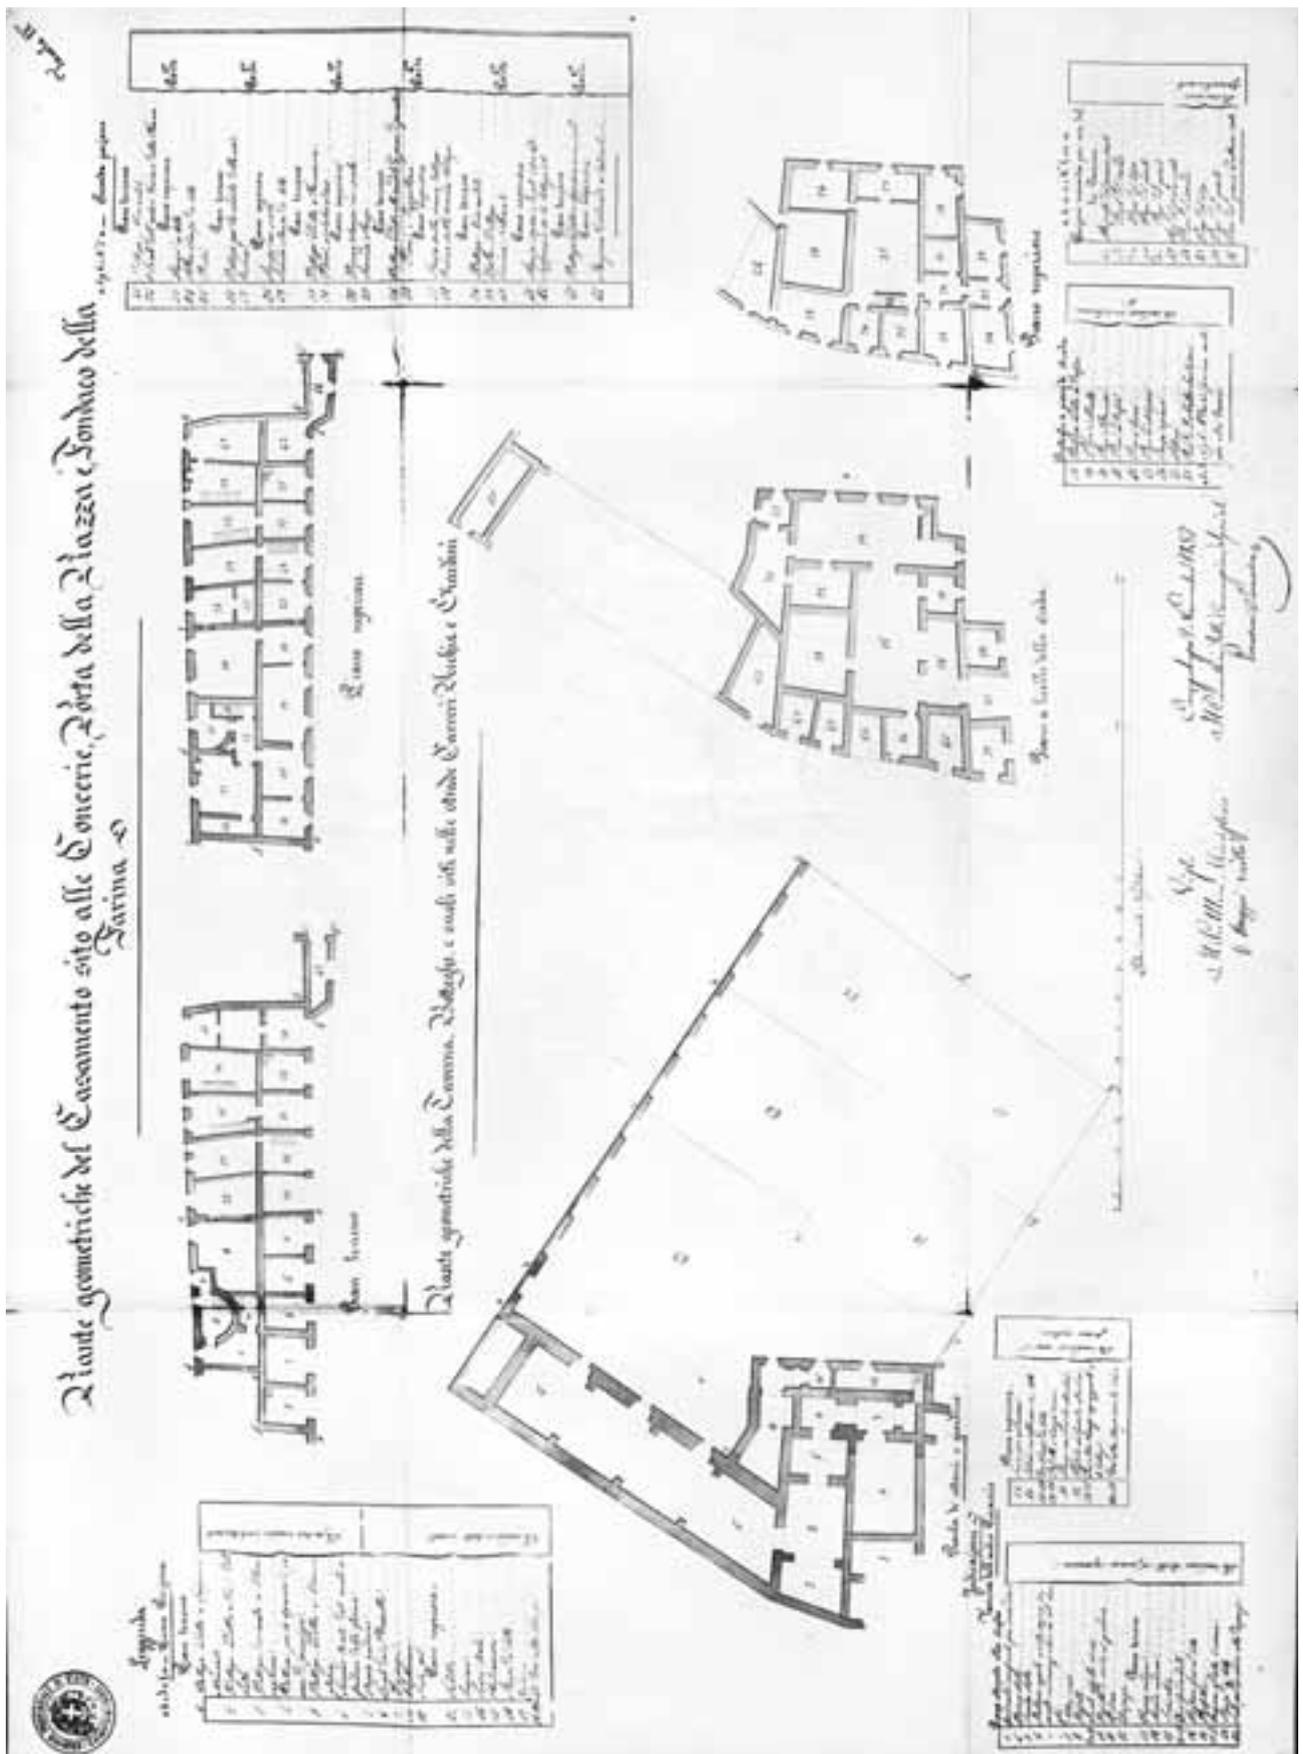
Pianta geometriche del Casamento sito alle Concerie, Porta della Piazza, Fondaco della Farina di Alessandro Mazzarotta, 1857 (cfr. nota 19).
